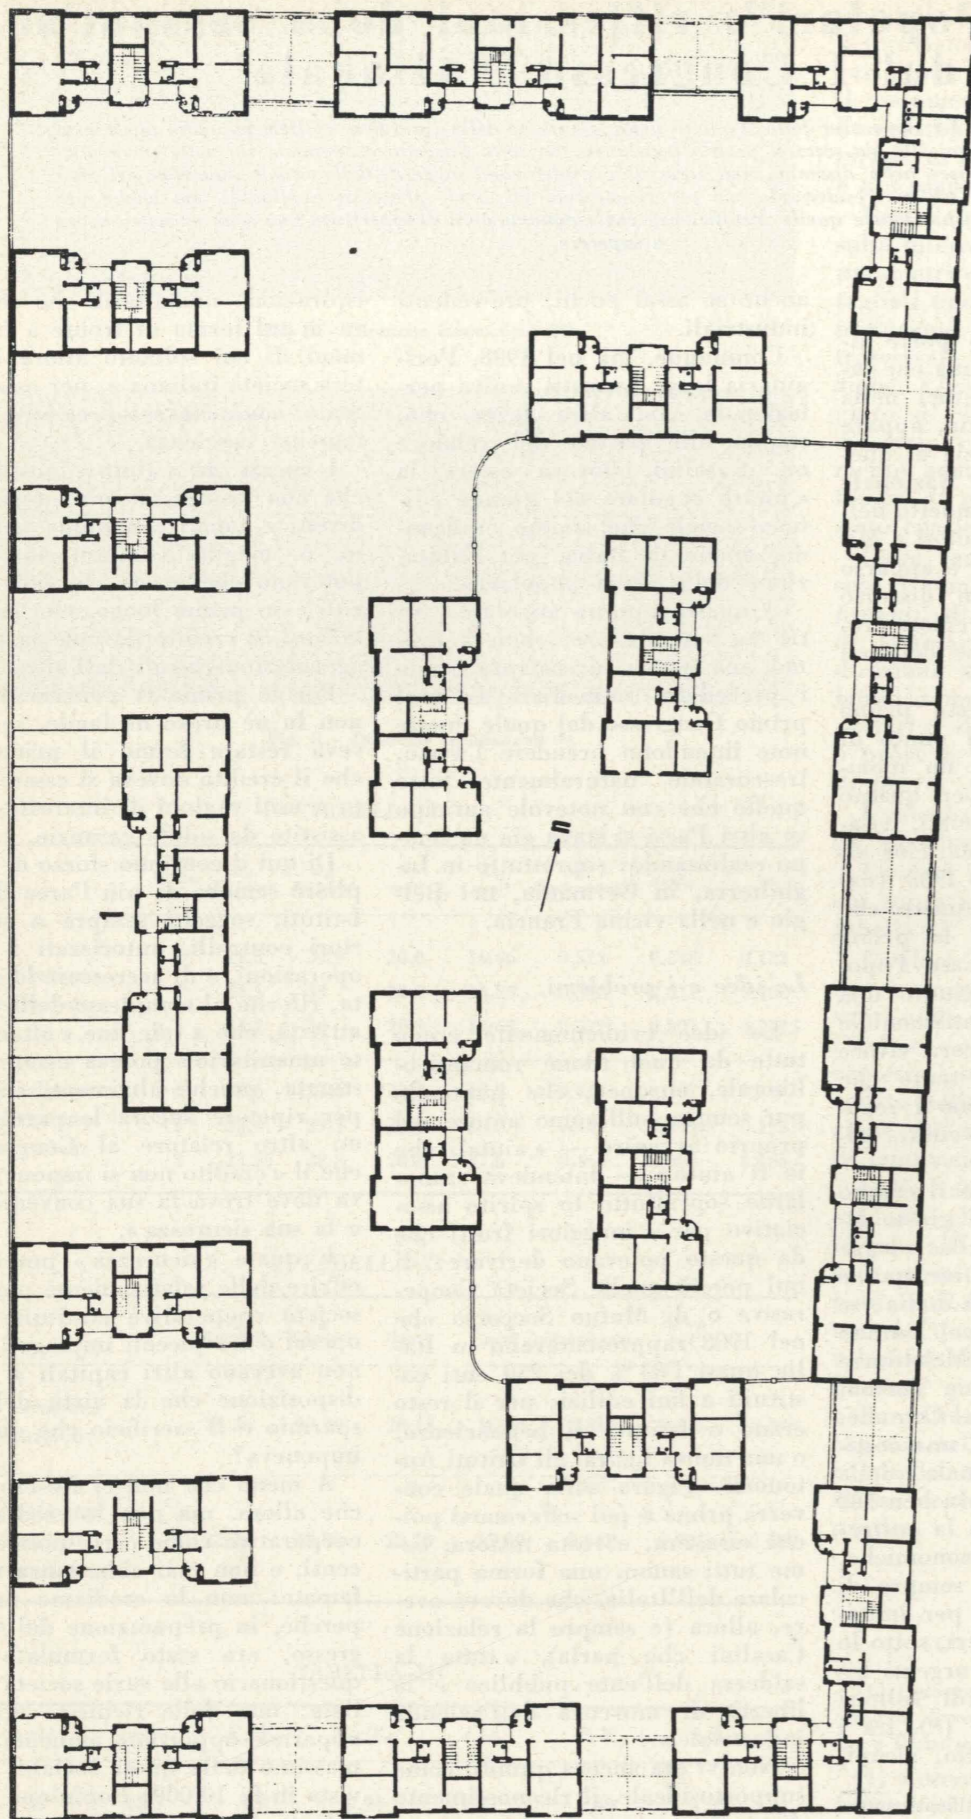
Progetto 1° classificato: la planimetria generale, con indicazione delle piante del piano tipo. 1: edificio con al p.t. i servizi generali.
